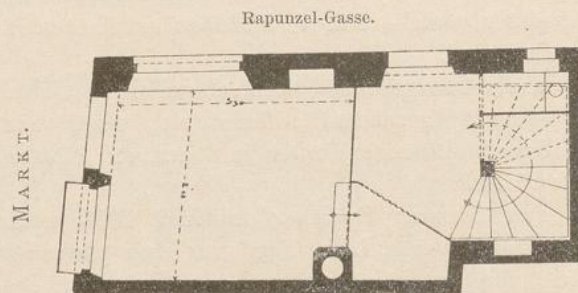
Kleiner Engel; Grundriss des Erdgeschosses.
